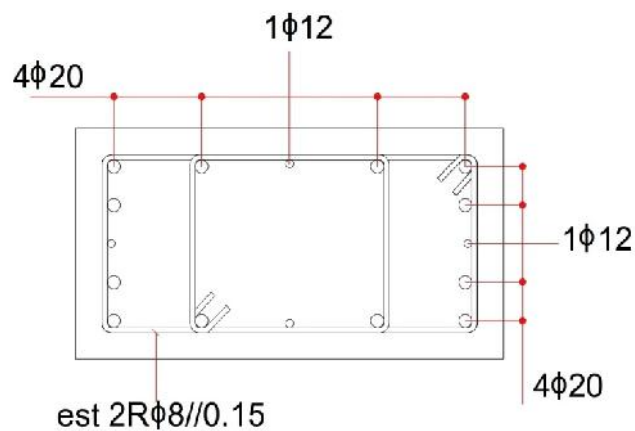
Pormenorização da secção inicial do pilar B1 do piso 0
